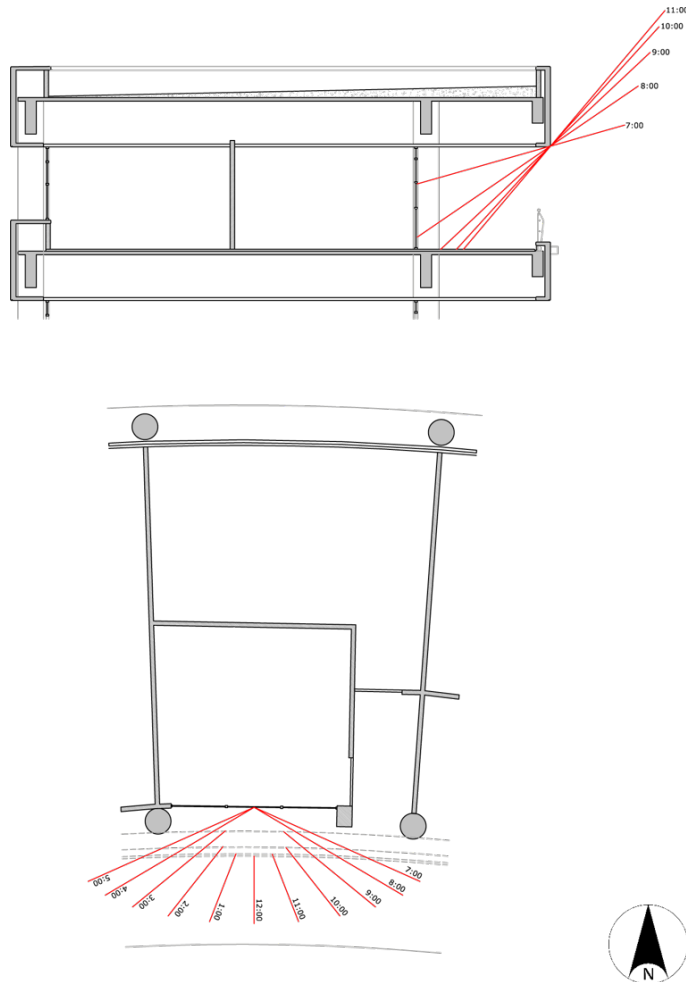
Corte y planta de las aulas F-303 y F-302 (orientación sur y norte respectivamente) con la incidencia solar por hora en enero.
